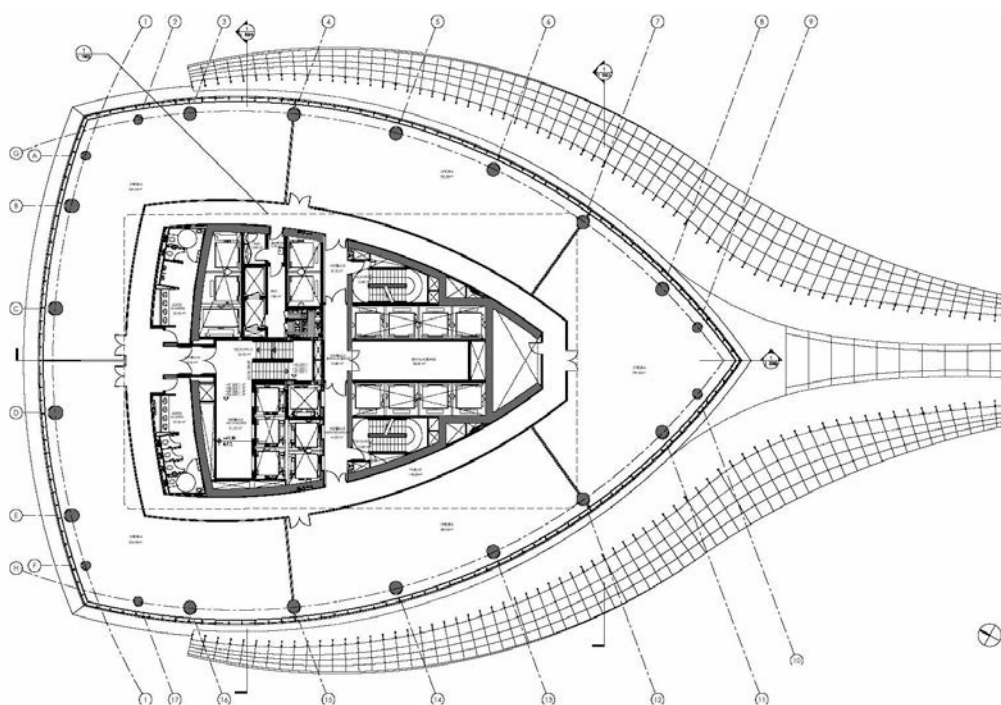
Planta tipo. (Fuente: Torre Iberdrola)
